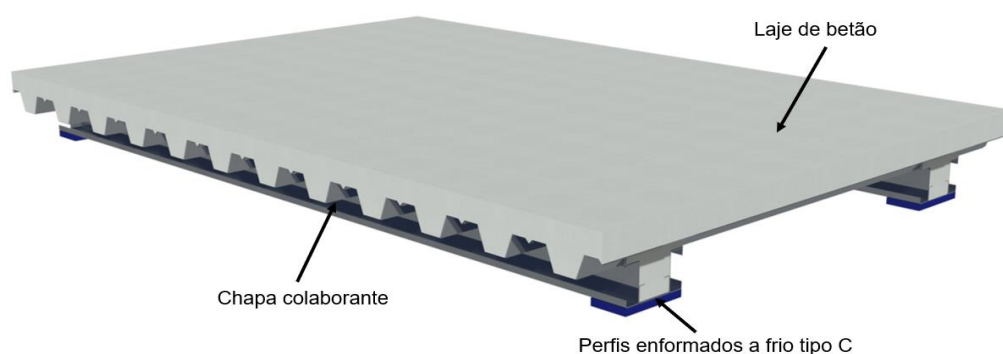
Pavimento misto em aço e betão com vigas metálicas em aço EF estudado nesta investigação.
